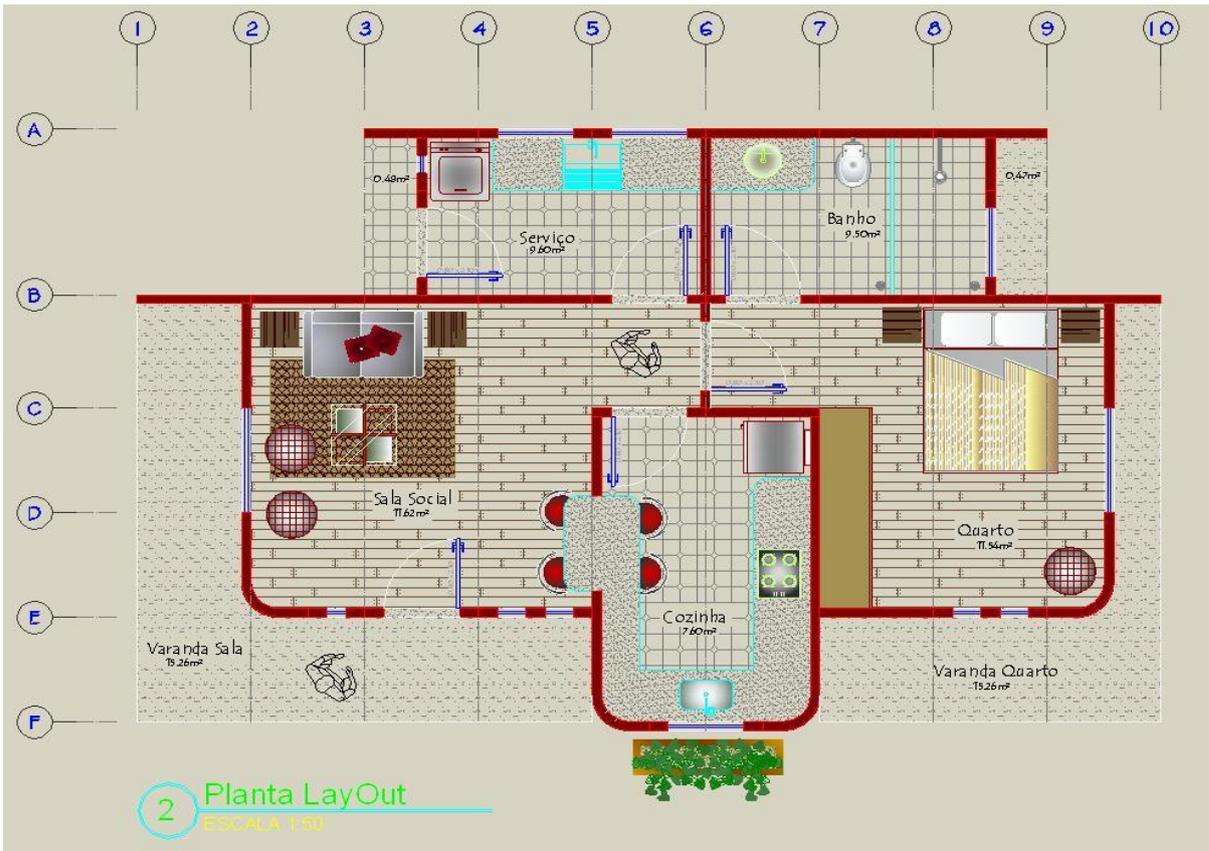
Planta Humanizada com sugestão da disposição do mobiliário. (Layout).
